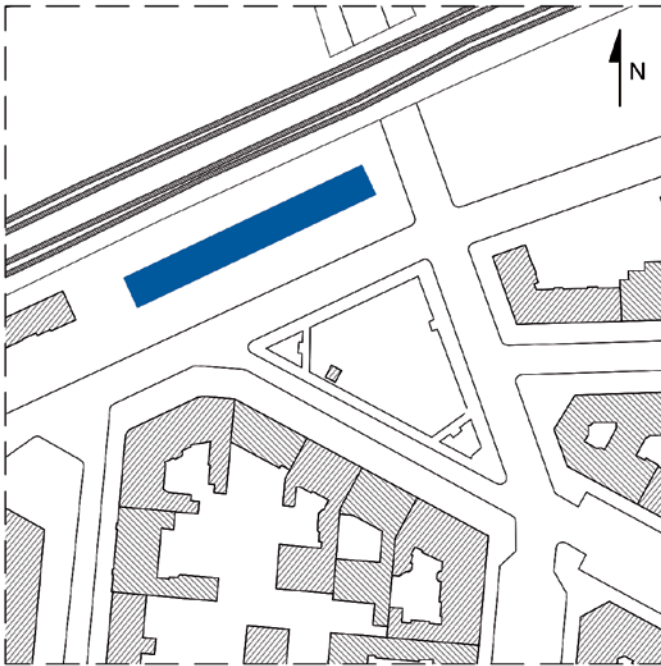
Lageplan des Typenentwurfs »Zeilensbau« in Ortbetonbauweise
